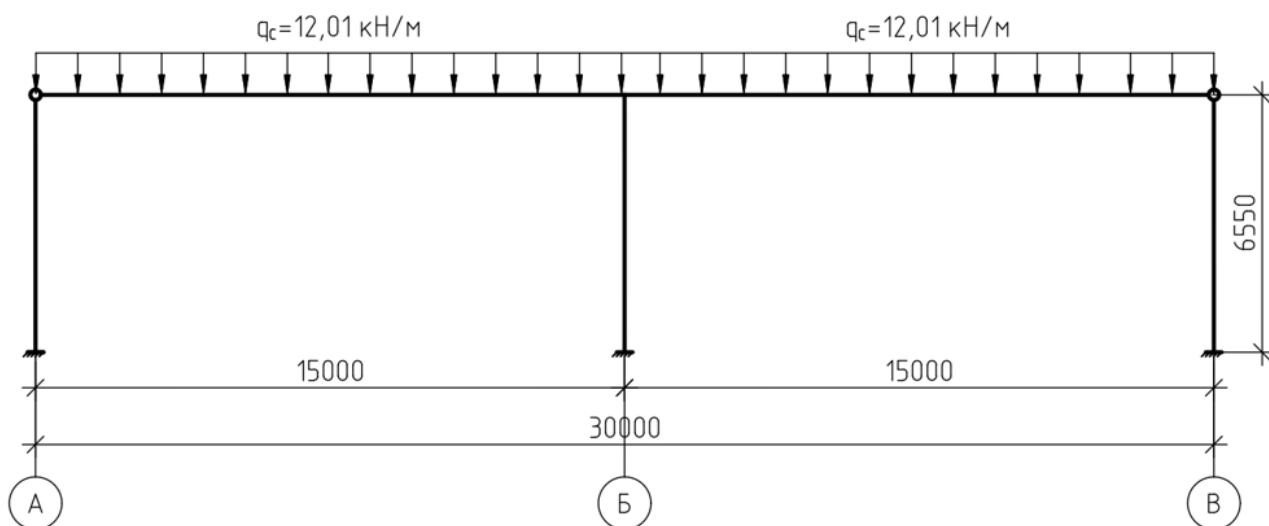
Загрузка поперечной рамы здания снеговой нагрузкой
